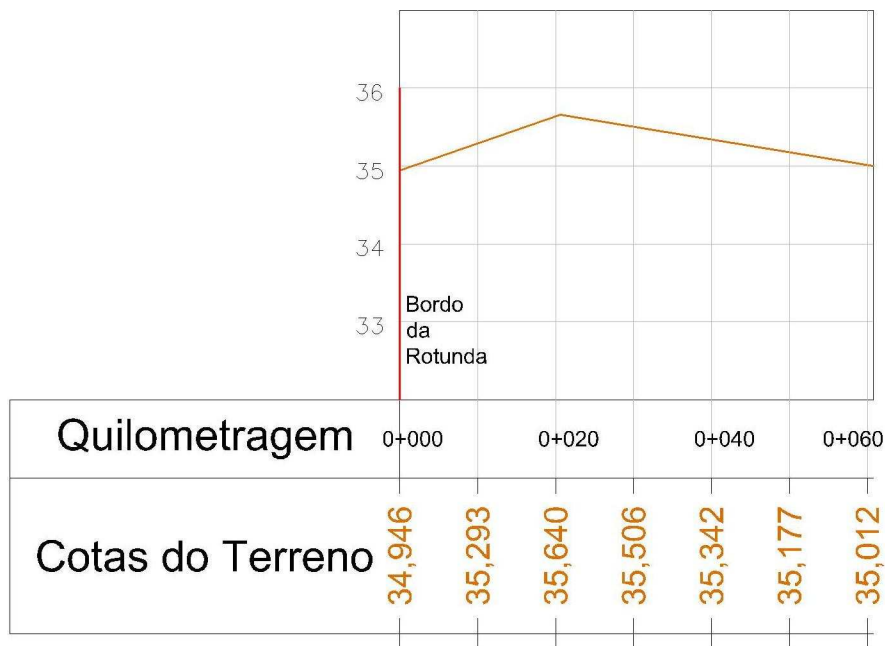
Perfil longitudinal do terreno pré-existente do Ramo E.
